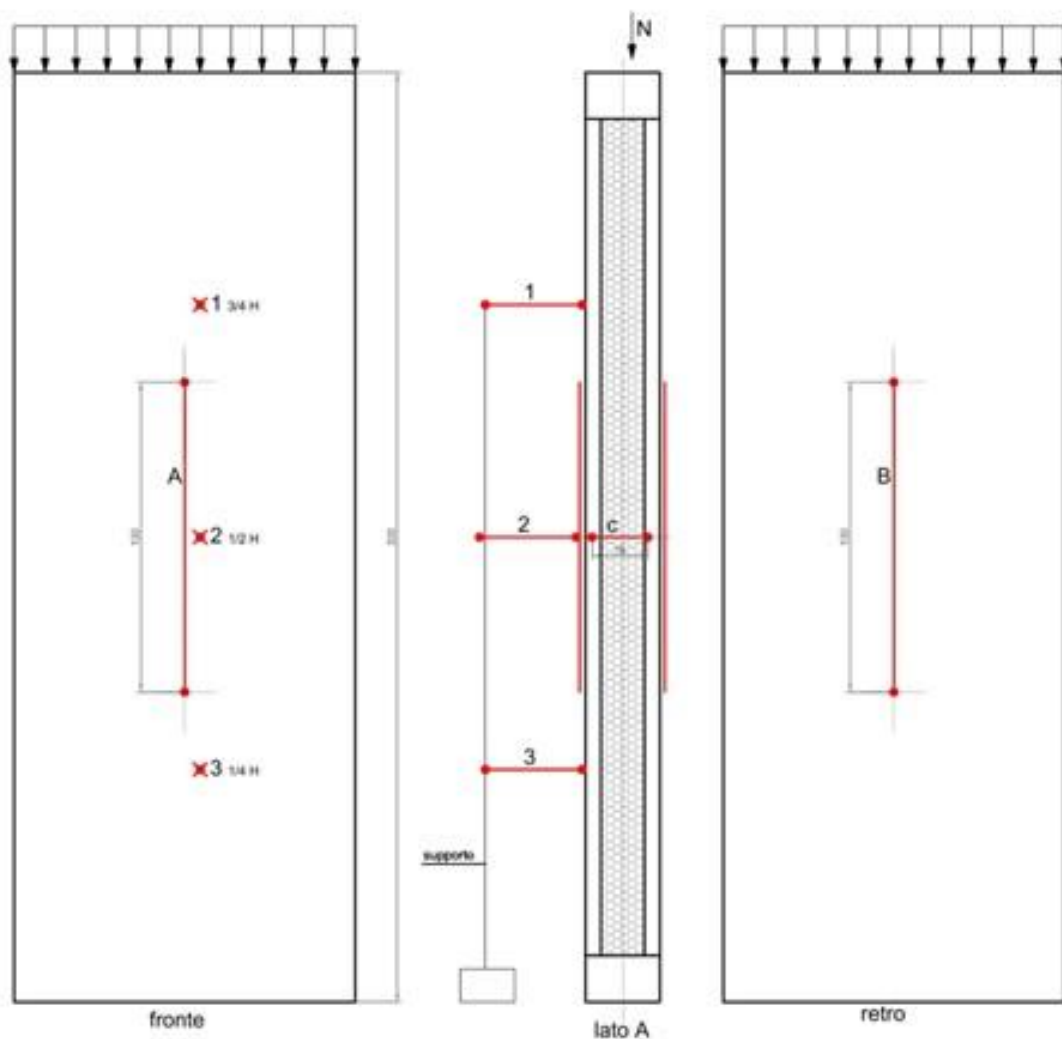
Disposizione dei trasduttori sulle facce fronte e retro, lato A del provino
